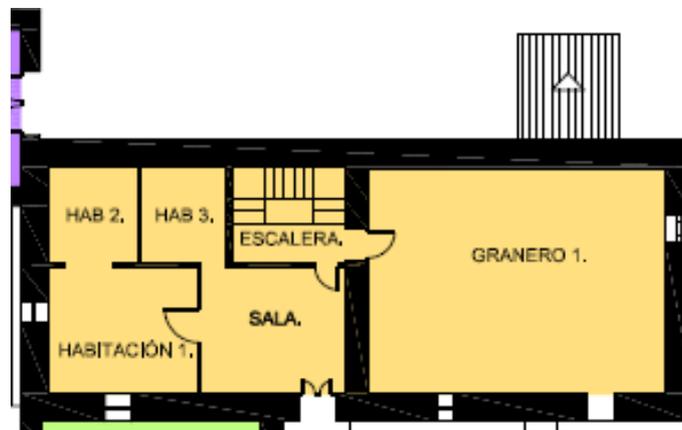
Plano distribución vivienda familiar en Planta Primera.
